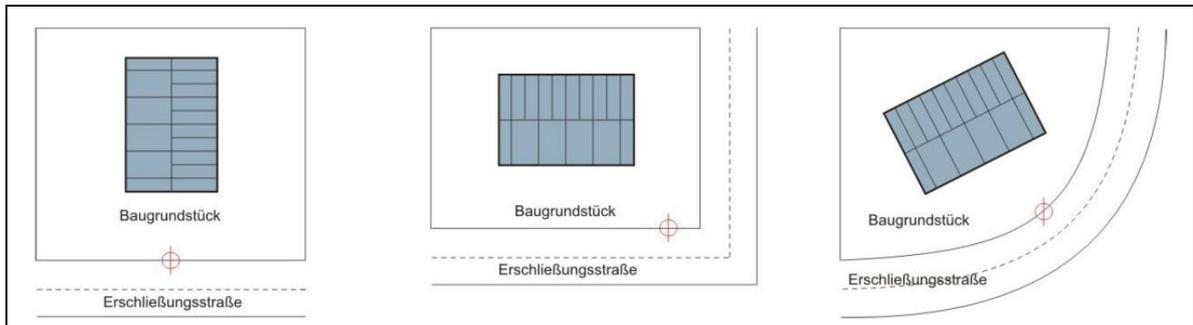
Prinzipskizze maßgebender unterer Bezugspunkt talseitige Grundstücke
